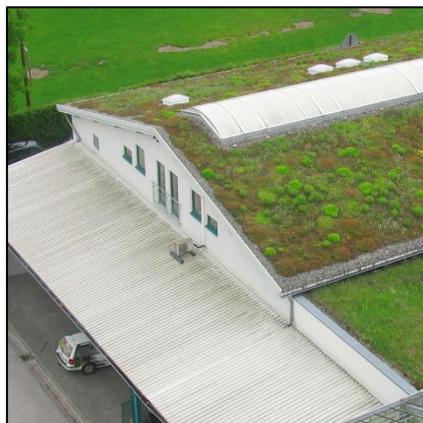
allgemeines Beispiel für extensive Dachbegrünung einer Gewerbehalle
